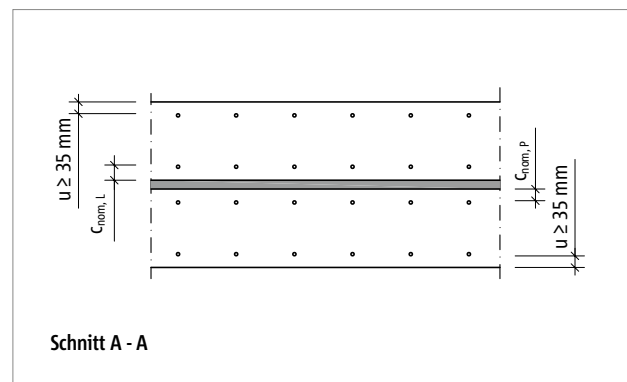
Schöck Tronsole® Typ BZ: Vertikalschnitt quer zur Treppe im Bereich des Konsolauflagers; Darstellung der Betondeckung $c_{nom,L}$, $c_{nom,P}$ und des Mindestachsabstandes u der Bewehrung
